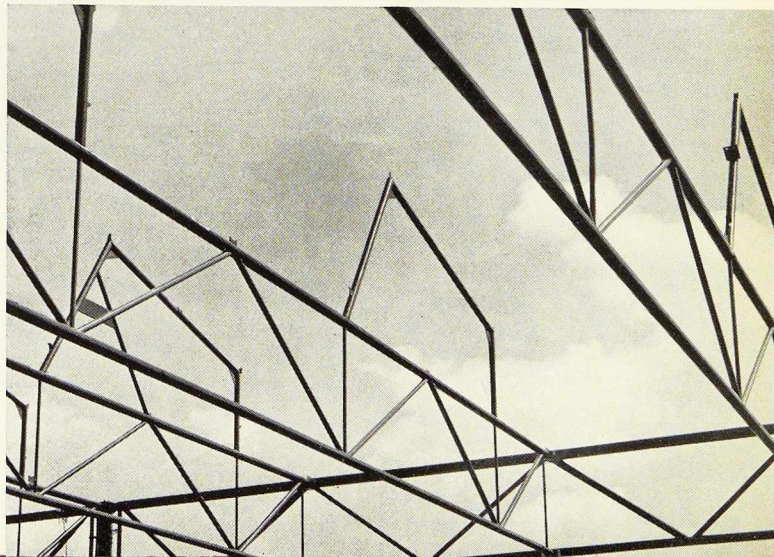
Usine Rotax. Vue d'un nœud de la charpente, prêt pour les travaux de soudure.
